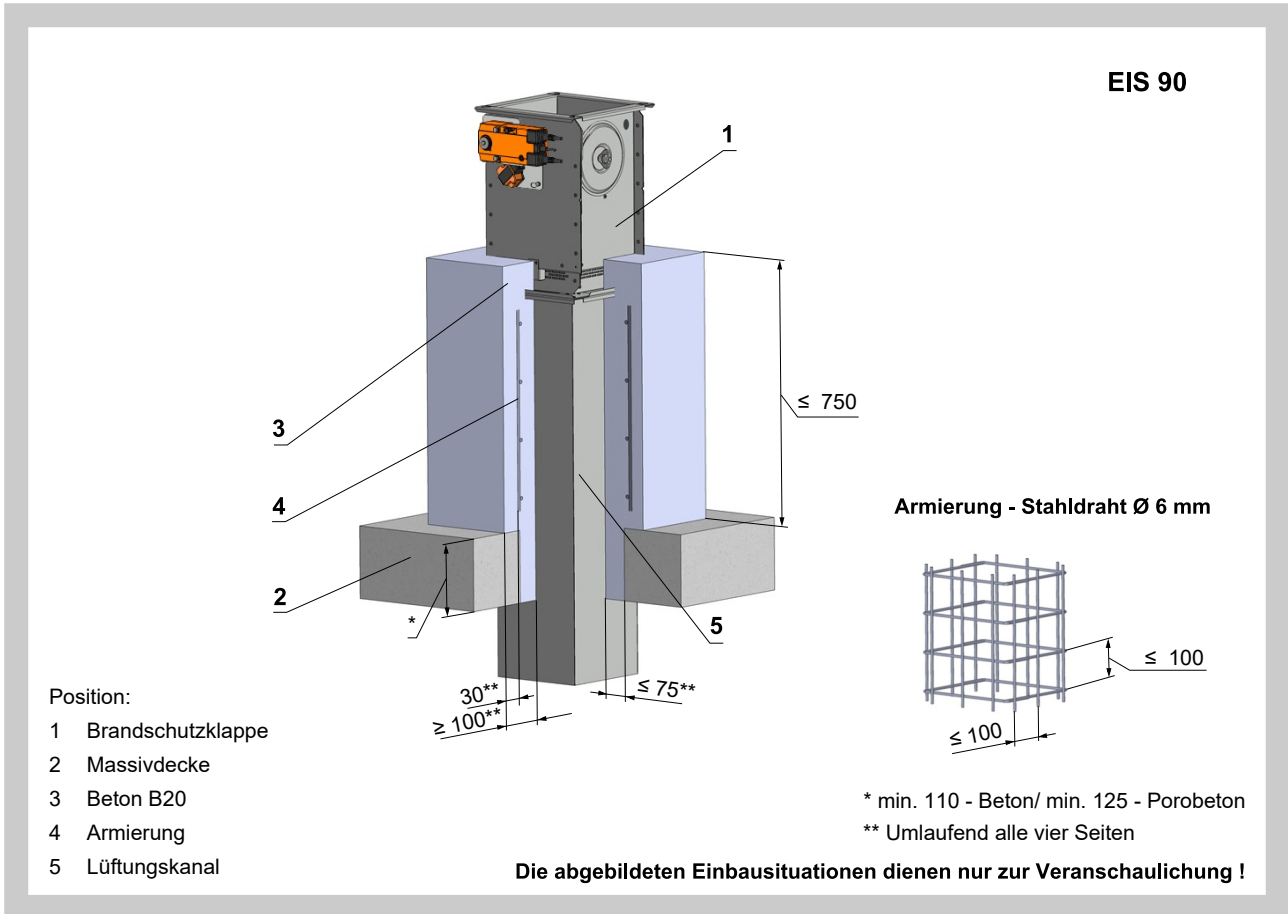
Außerhalb der massiven Deckenkonstruktion - beton und Einbaurahmen E4
